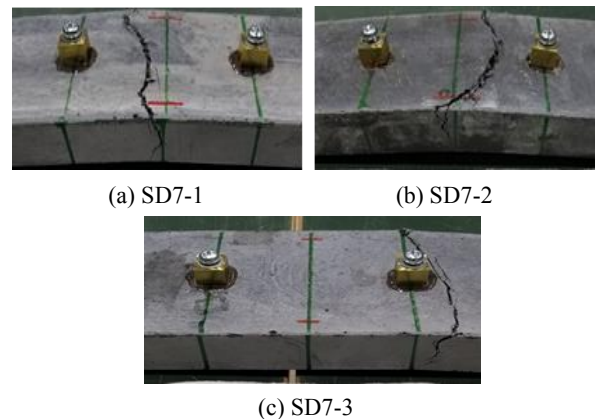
4点曲げ載荷供試体のひび割れ状況
